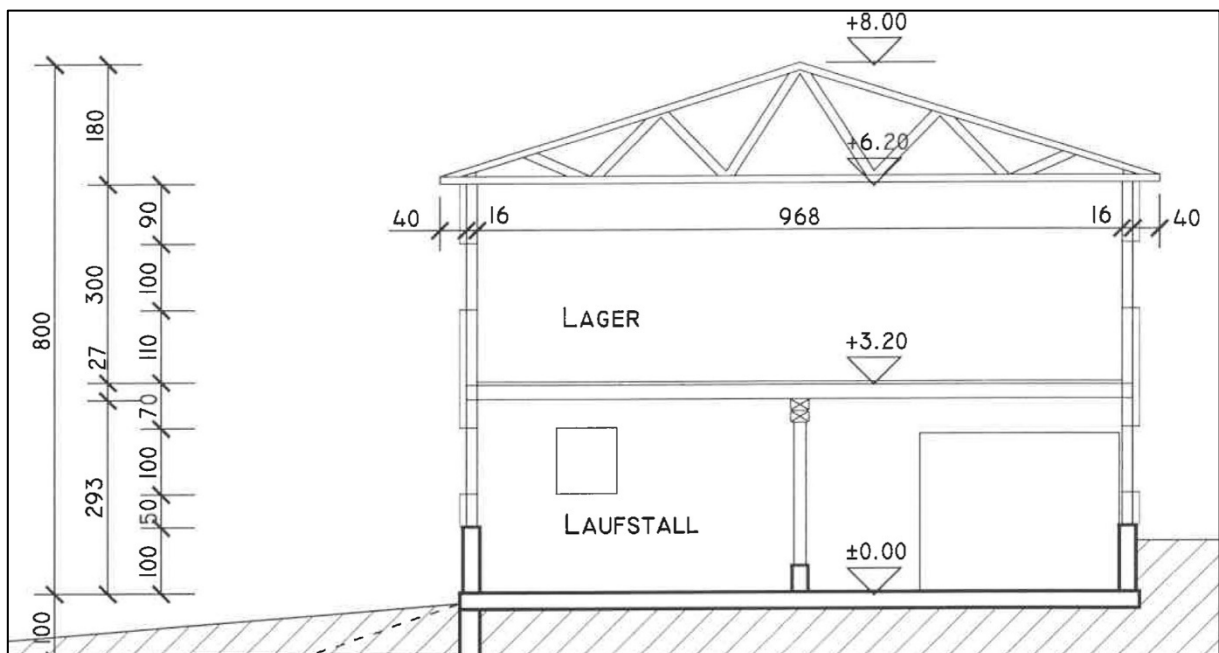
Querschnitt durch das Wirtschaftsgebäude aus 1999; über der Holzbalkendecke auf dem Stall wurde ein Lagerraum mit 3,00 m lichter Höhe unter einem Satteldach mit Nagelbindern errichtet.
